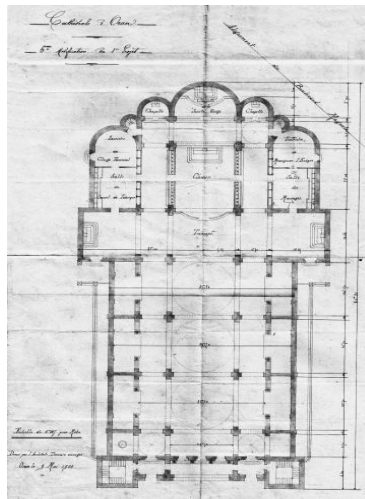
Plan du troisième avant-projet d'Albert Ballu du 9 mai 1900.
